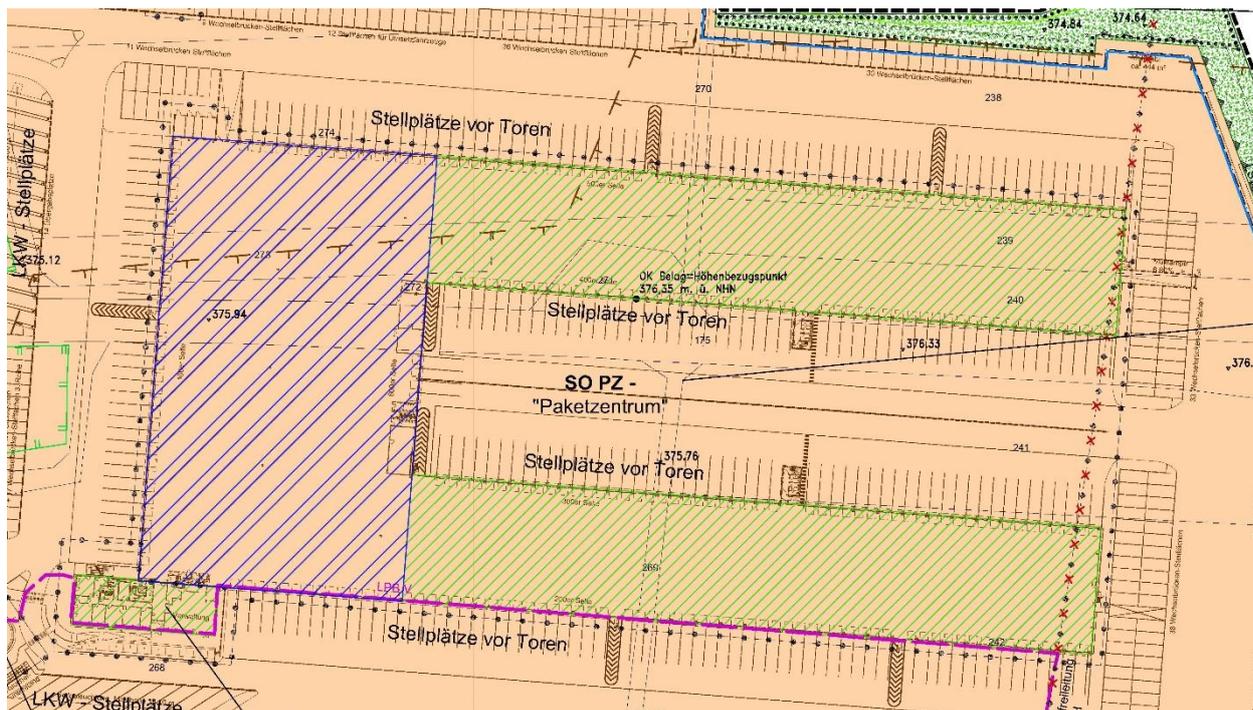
Baufelder Frachthalle und Verwaltungsgebäude
